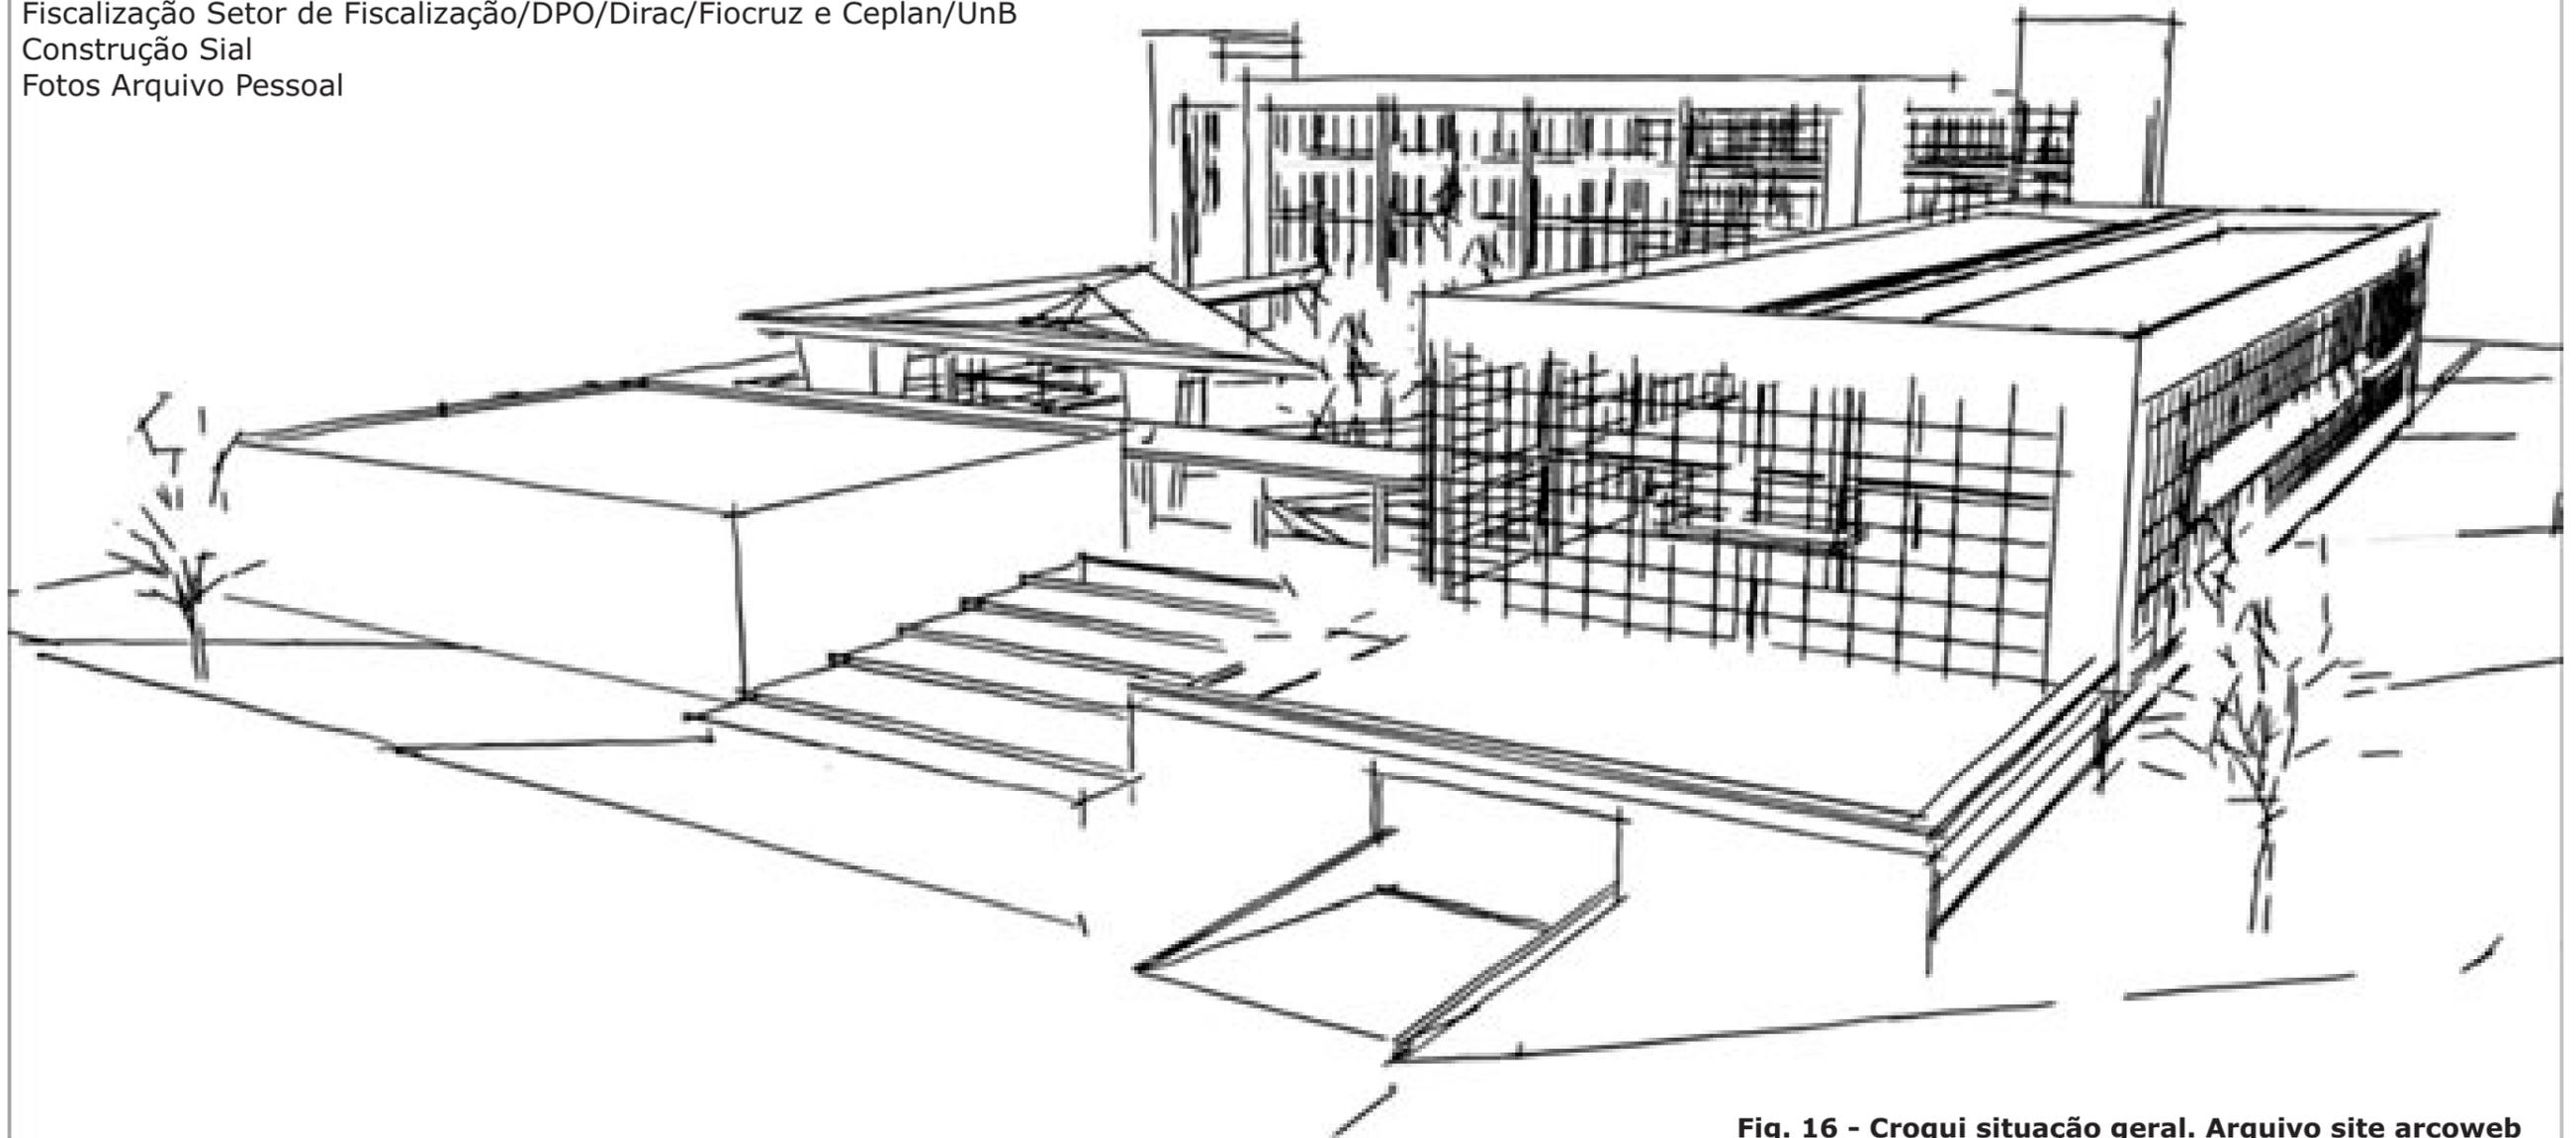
Croqui situação geral. Arquivo site arcoweb
